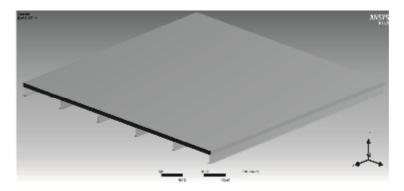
Модель сталежелезобетонной плиты с ребрами из прокатных двутавров
